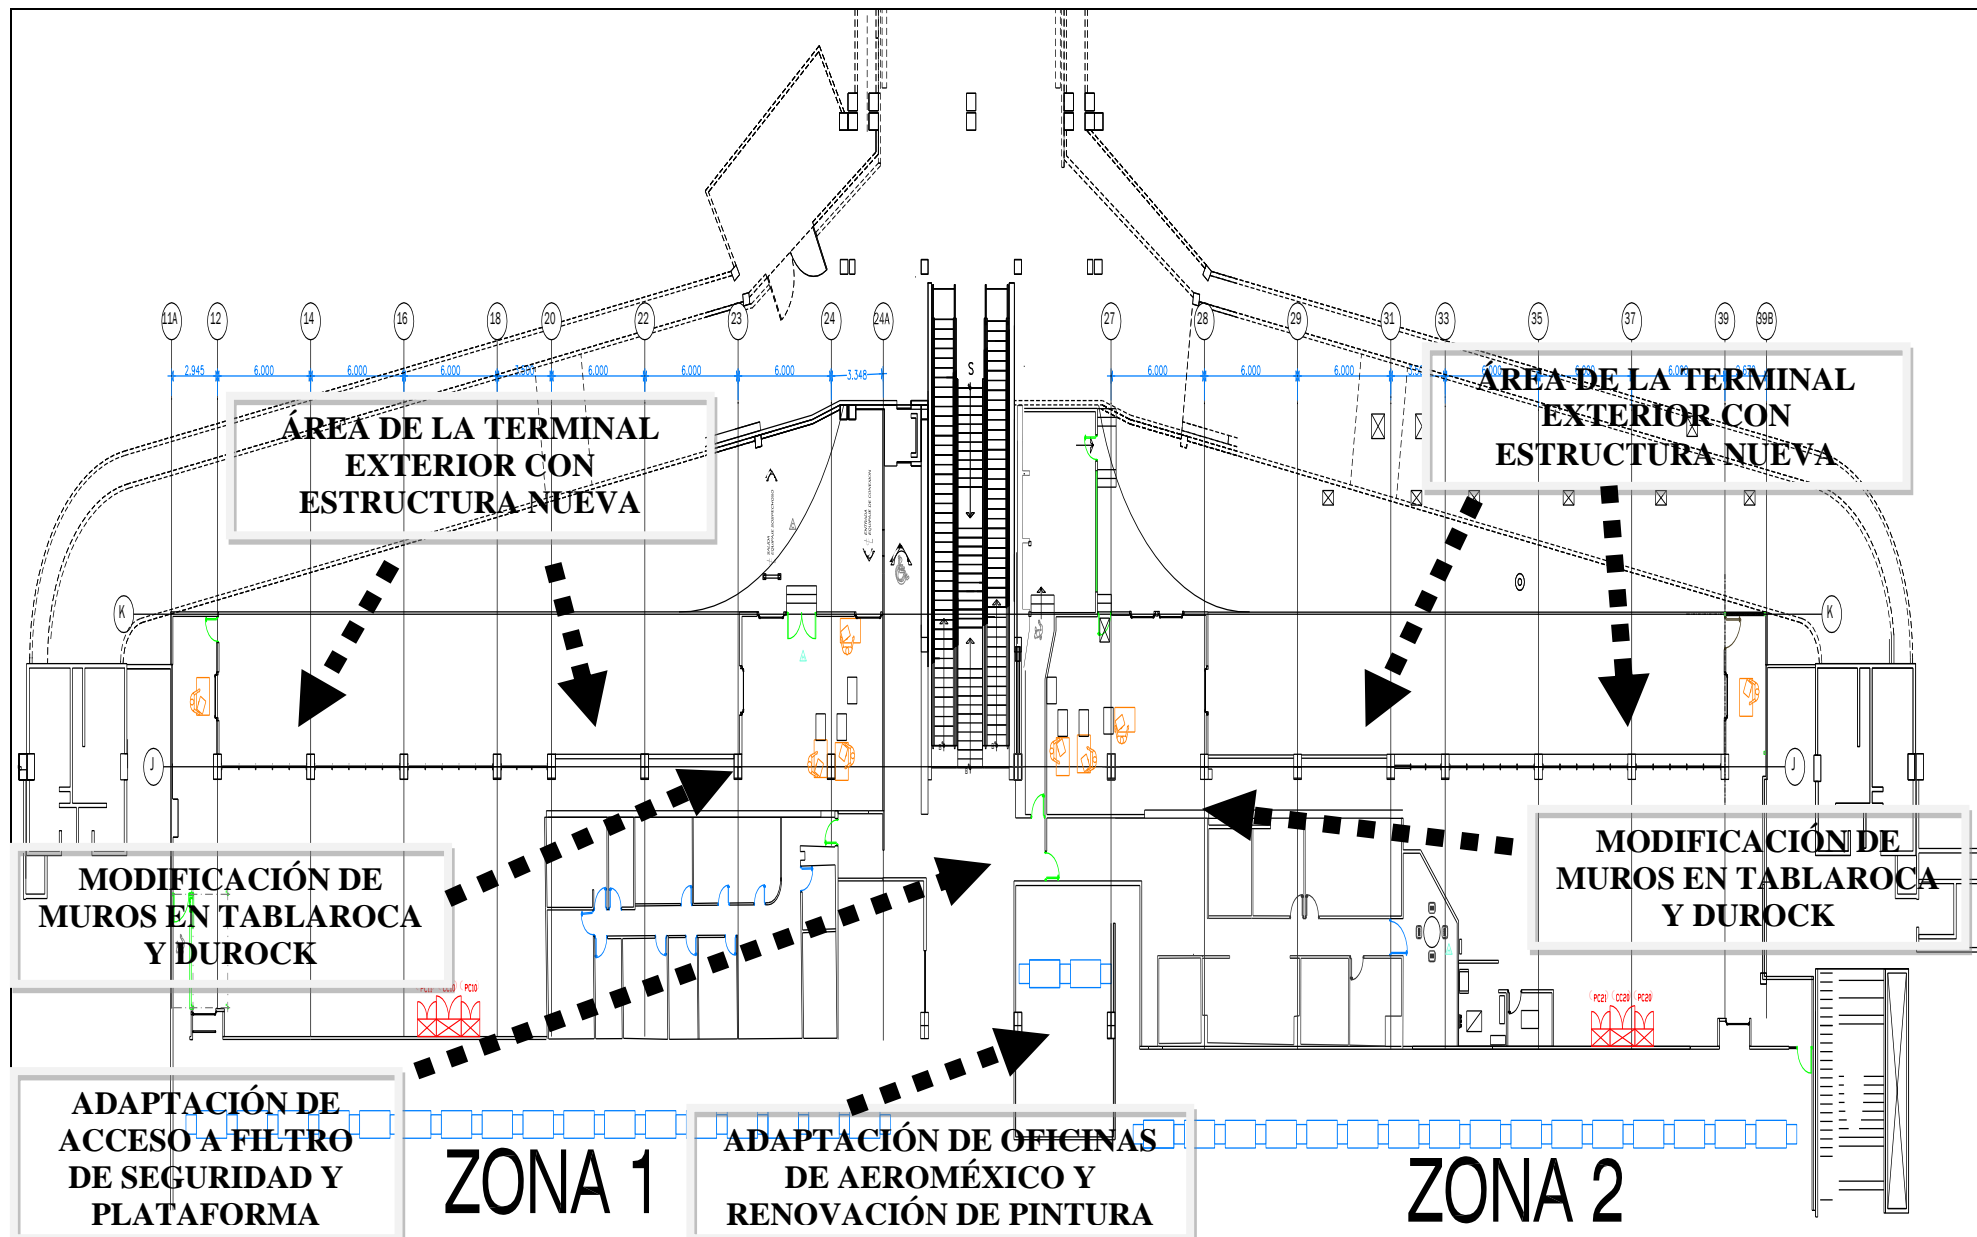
Plantas generales de remodelación en las zonas específicas de la terminal A (Siemens, 2010)
